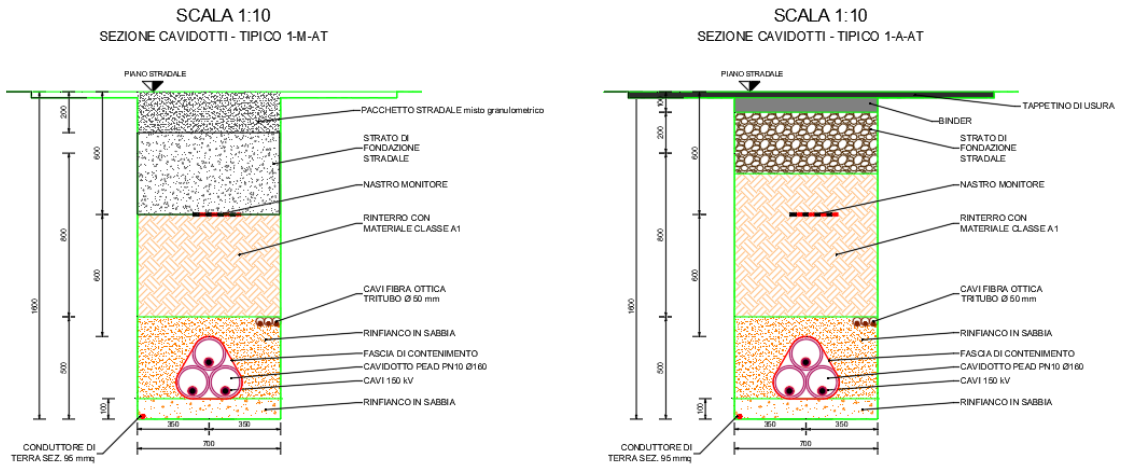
Sezione tipo cavidotto AT su strada asfaltata e mistata
